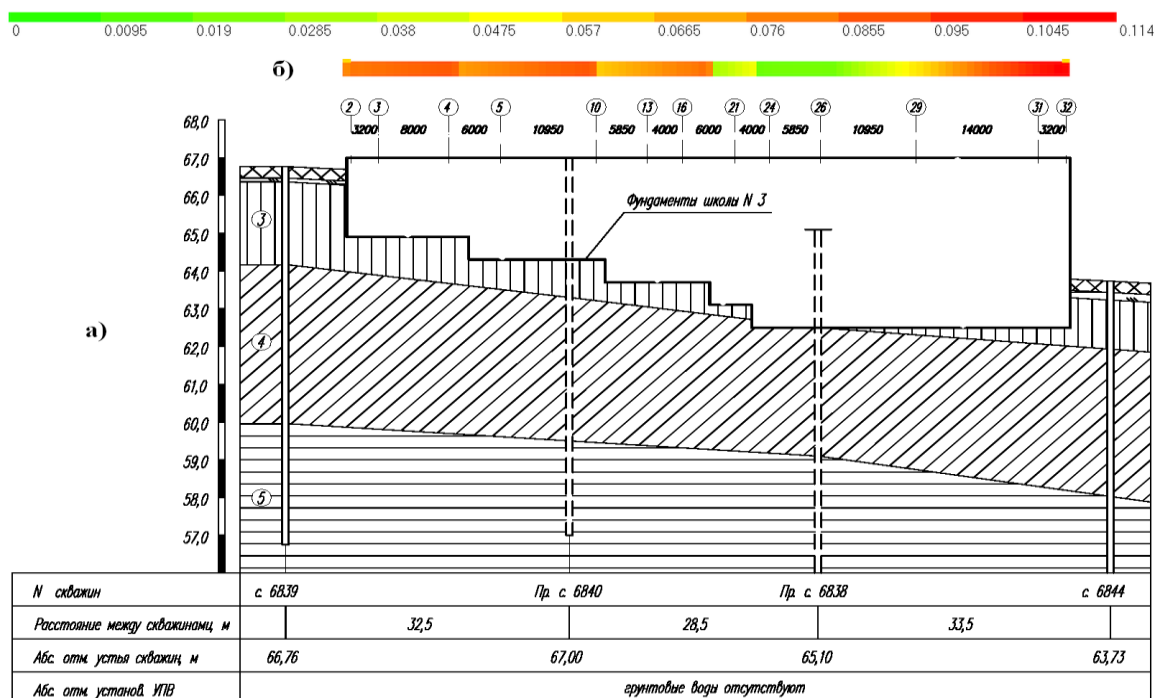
Инженерно-геологический разрез вдоль главного фасада школы:
